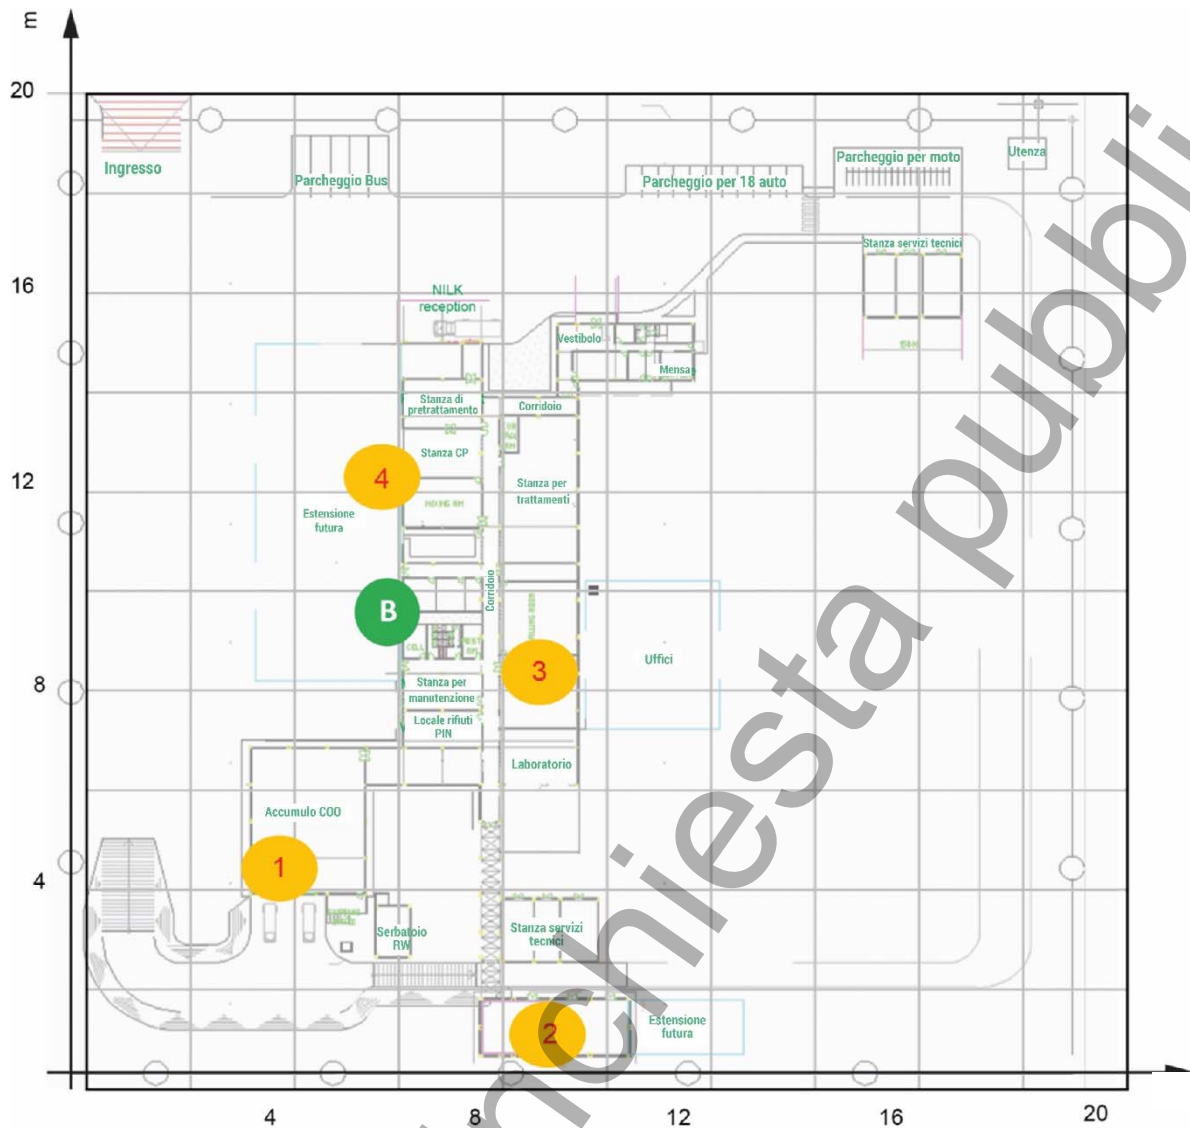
Esempio 1: Pianta dell’impianto di produzione con i carichi previsti e il baricentro calcolato
